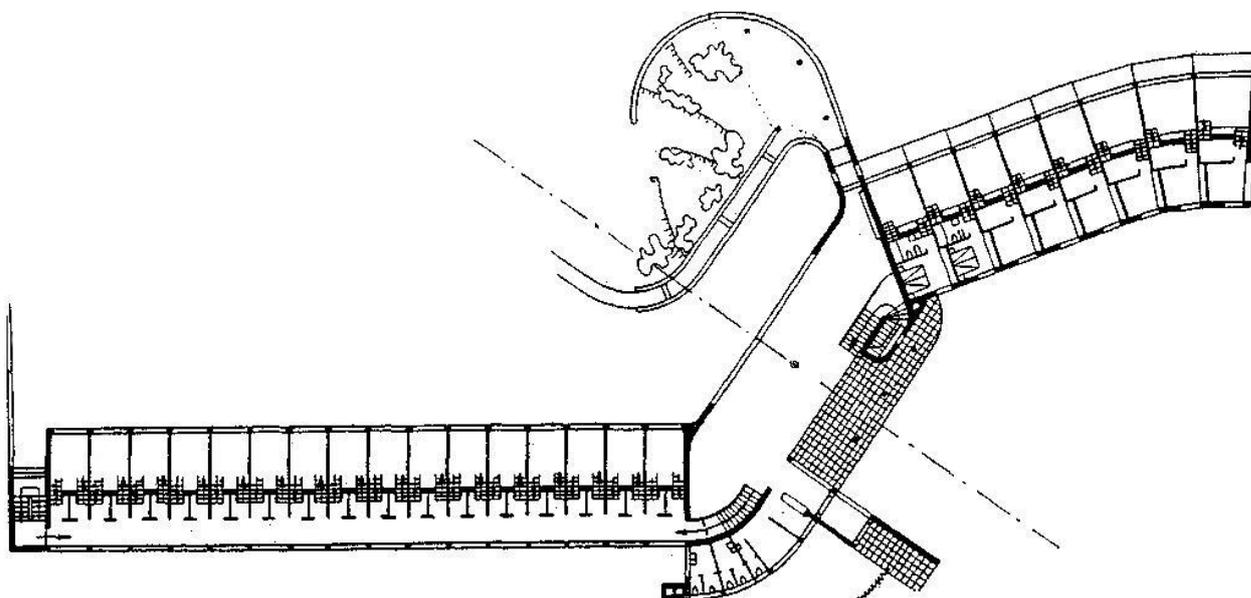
Жилое здание на выставке Веркбунда. Бреслау (Вроцлав)
